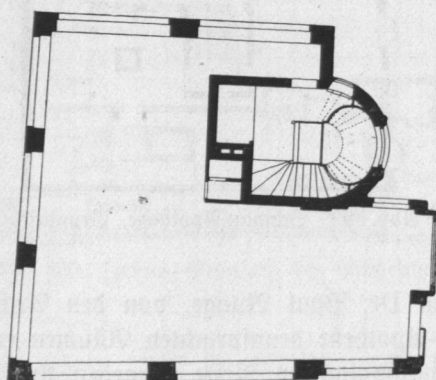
Hulbe-Haus, Grundriß des Erdgeschosses.
